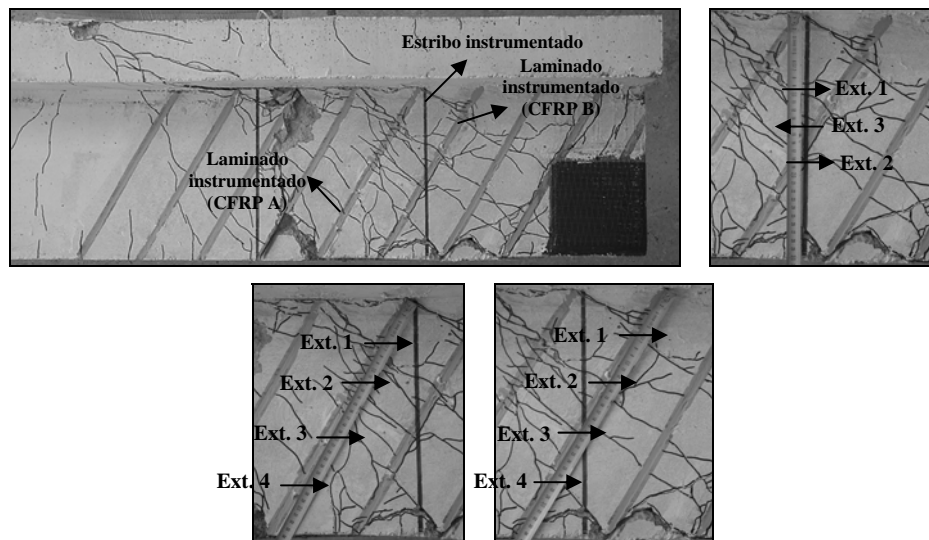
Localização dos extensómetros no laminado e estribo instrumentados da viga 2S-9LI60-B.
